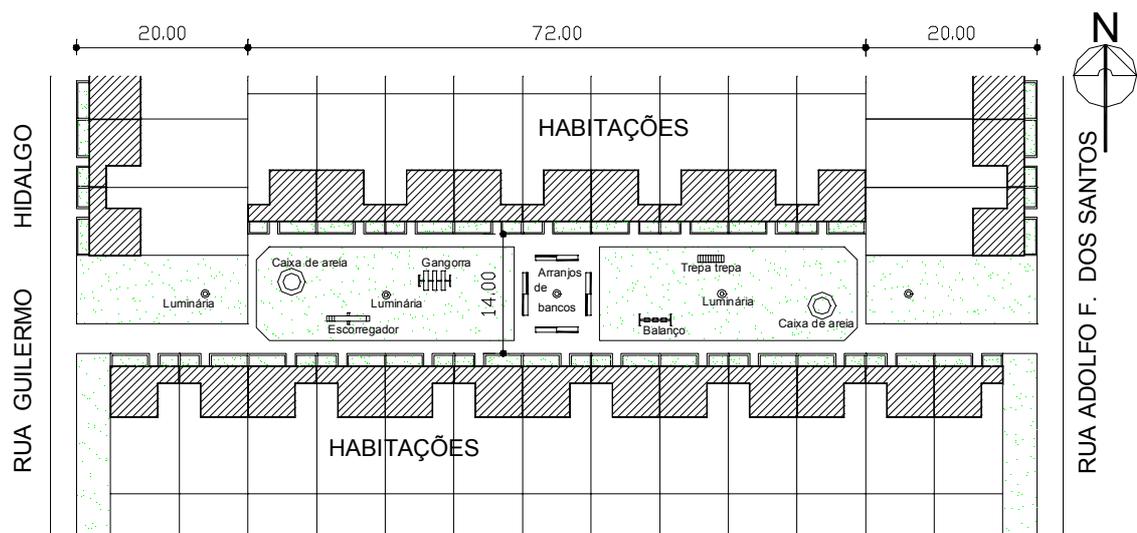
Planta Original do Espaço Aberto Comum 1 do CHST
